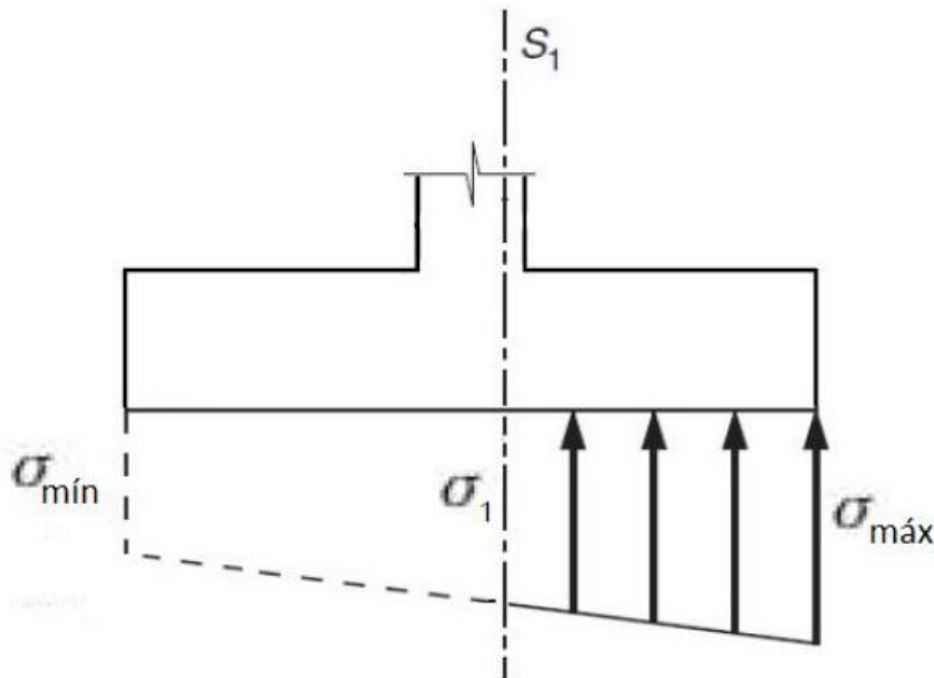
Alzado de zapata indicando sección S_1 ubicada $0,15a$ desde el borde del pilar.
